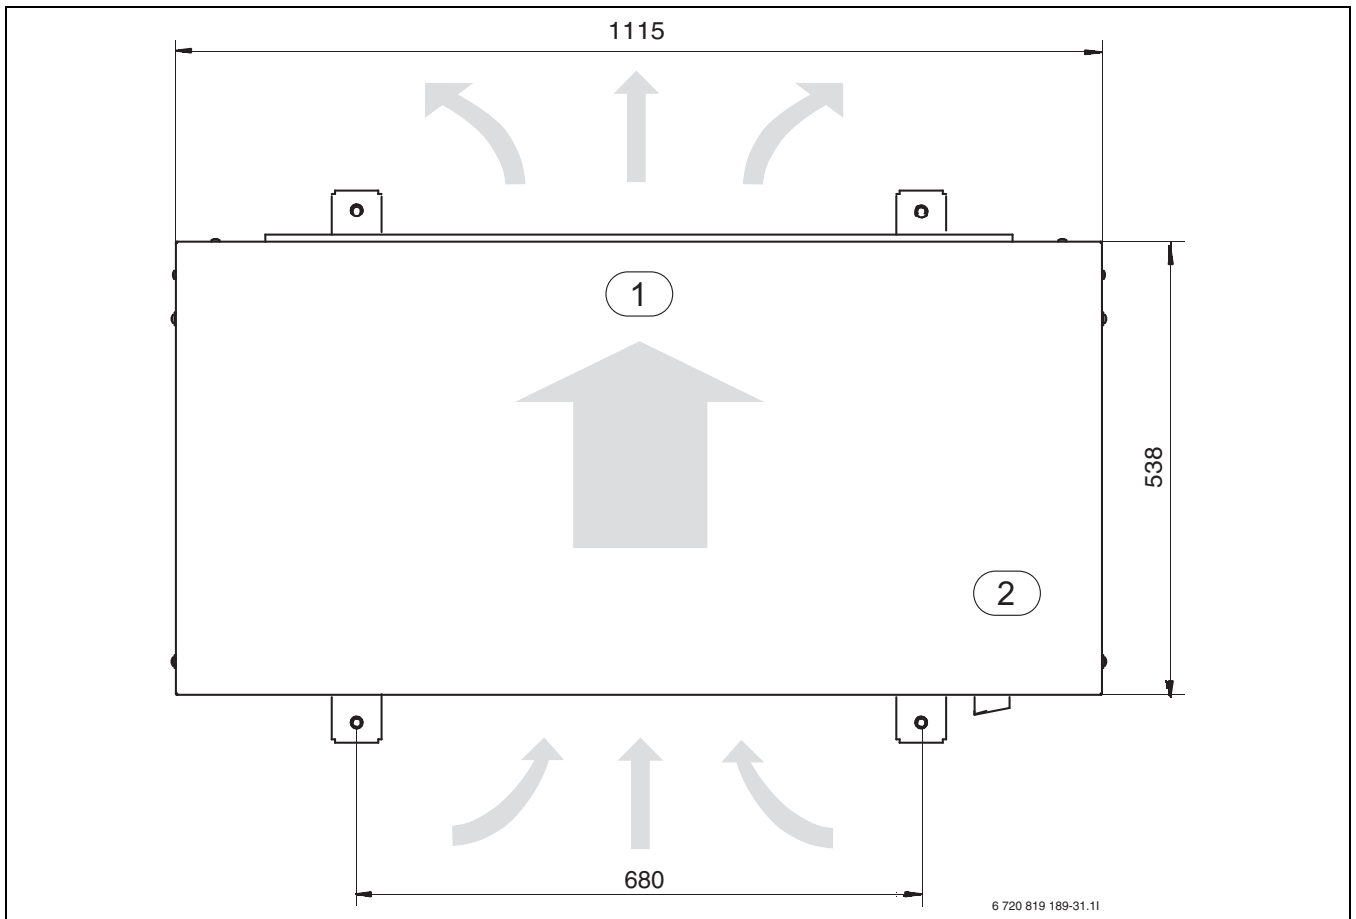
Rozměry tepelného čerpadla řady 6-8, půdorys
